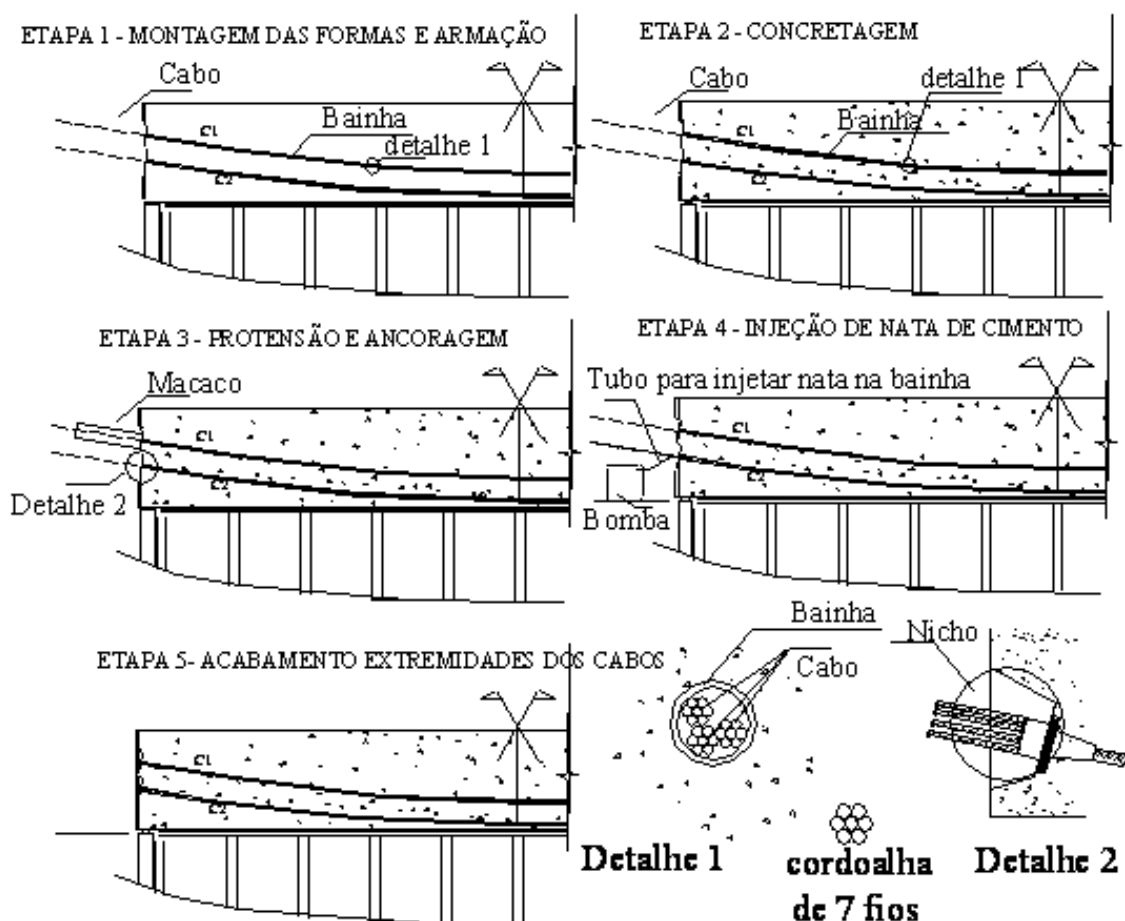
Etapas de protensão de uma viga executada com concreto protendido com aderência posterior.
